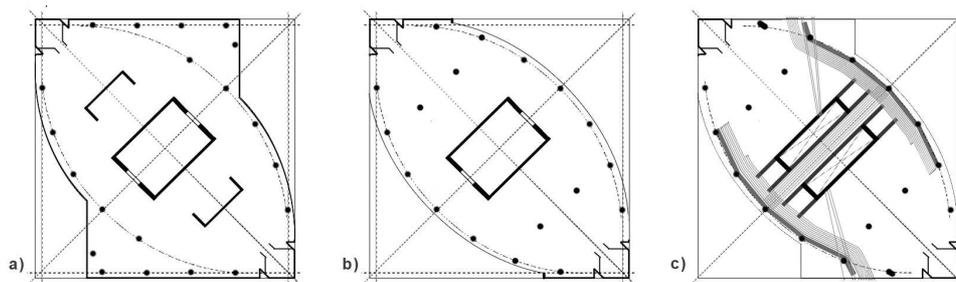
Diferentes plantas de la Torre Espacio: a) Planta inferior, b) planta alta c) estructura estabilizadora con el anillo rígido.
